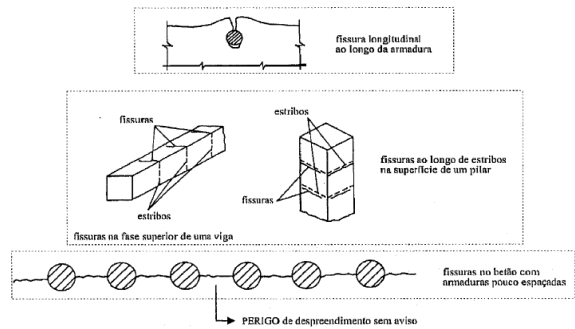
Fissuras por assentamento plástico (CEB, 1992)
